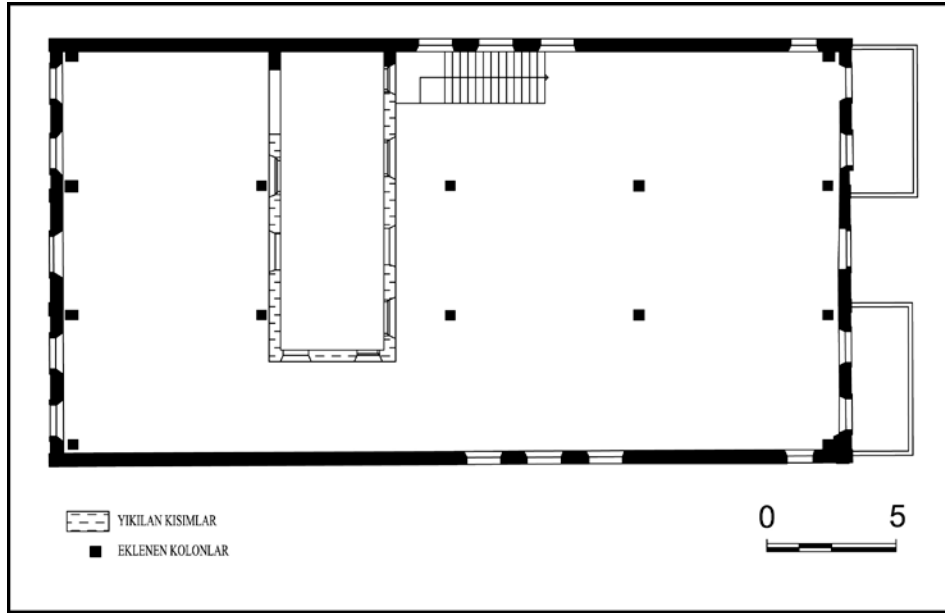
II. Dönem Taş Bina 1. Kat Plan Şeması
